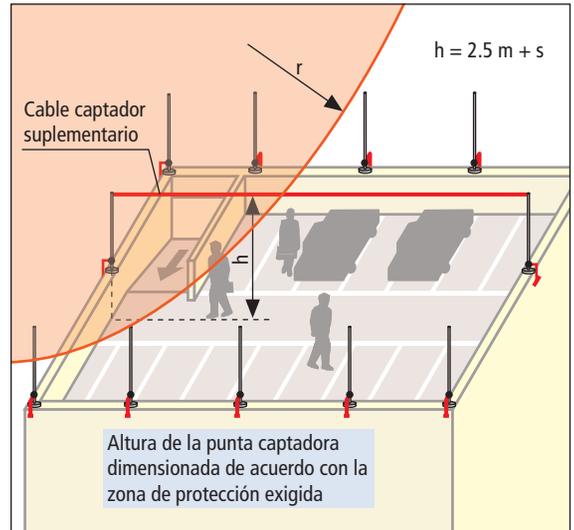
Protección contra rayos de aparcamientos en cubierta – Protección de las personas y del edificio (UNE EN 62305-3); Anexo E.
